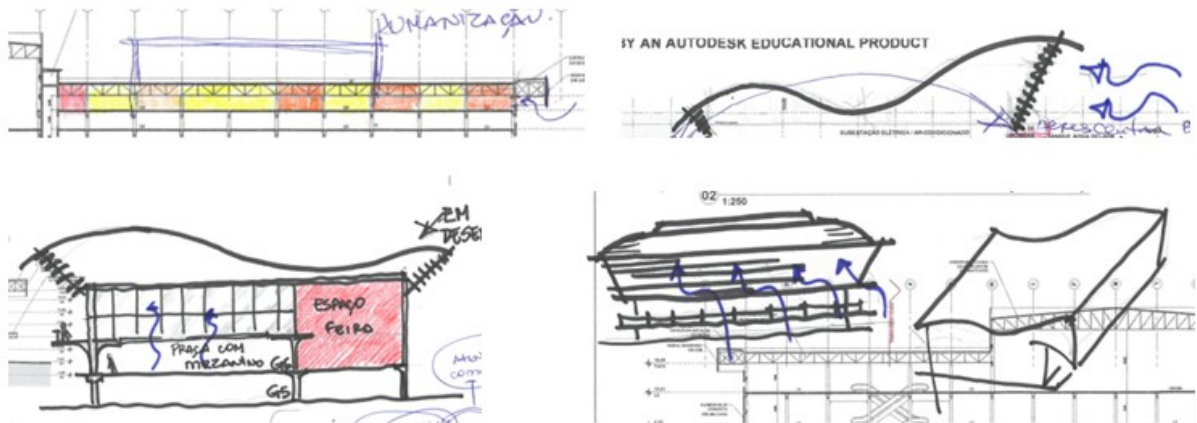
Proposta de zoneamento para a intervenção arquitetônica no Shopping Midway Mall no pavimento G6
